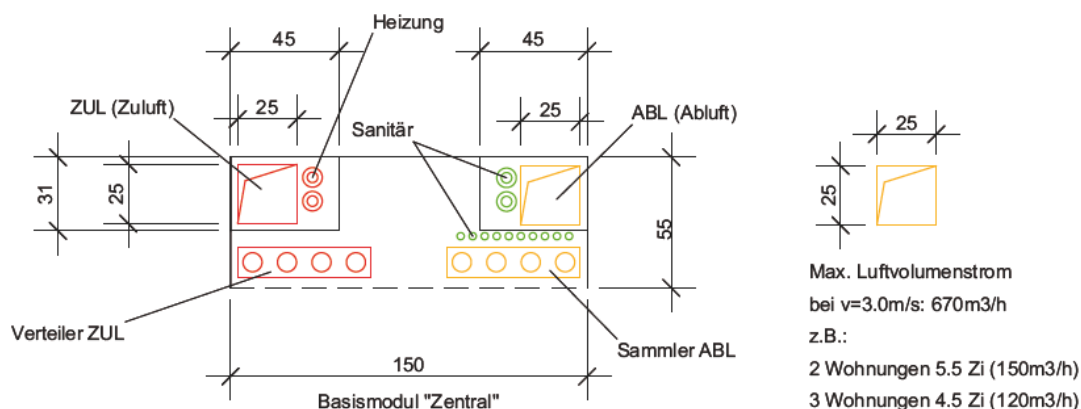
Grundriss Abmessungen Basismodul, Luftaufbereitung zentral
